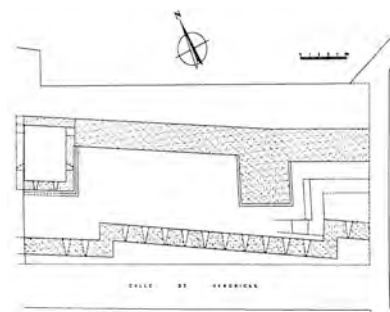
Reconstrucción de la planimetría de la muralla tras la campaña de excavación del año 2000. (Navarro, 2000a)
